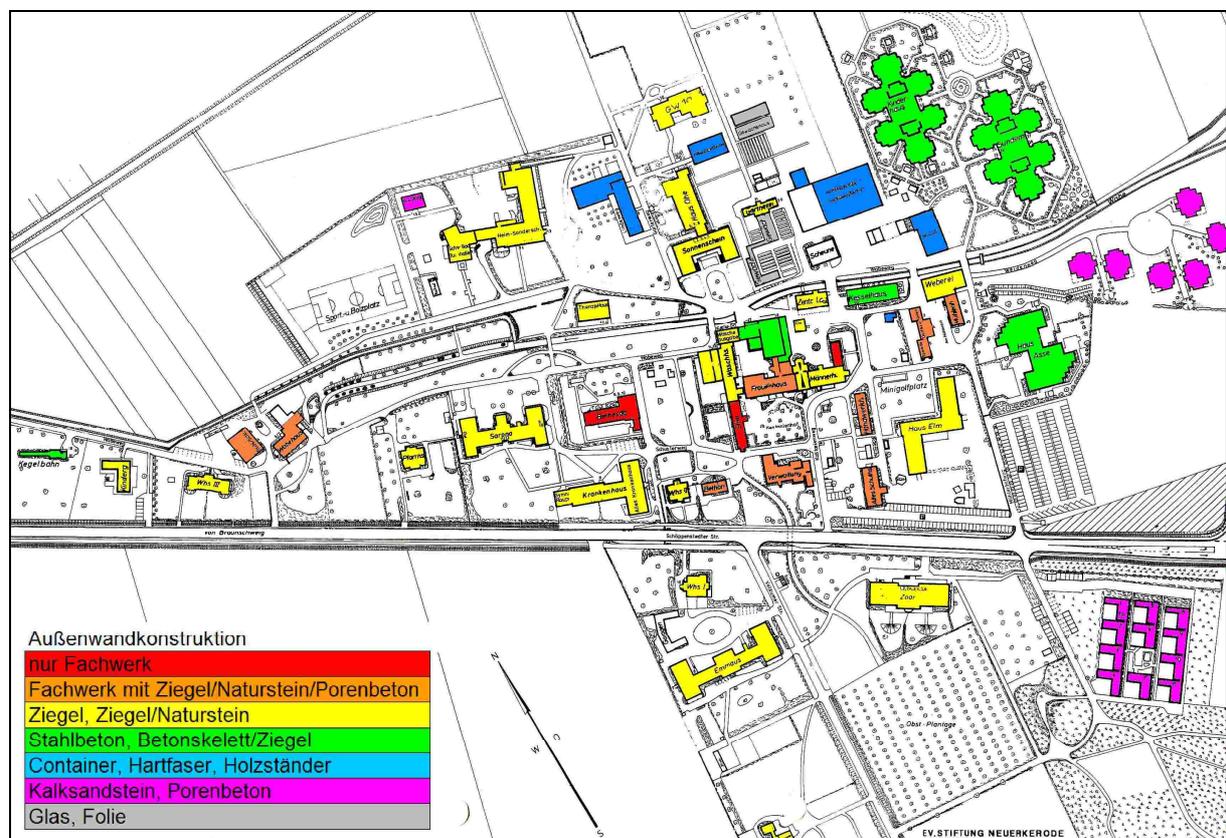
Art der Außenwandkonstruktionen (Grundprinzipien)
